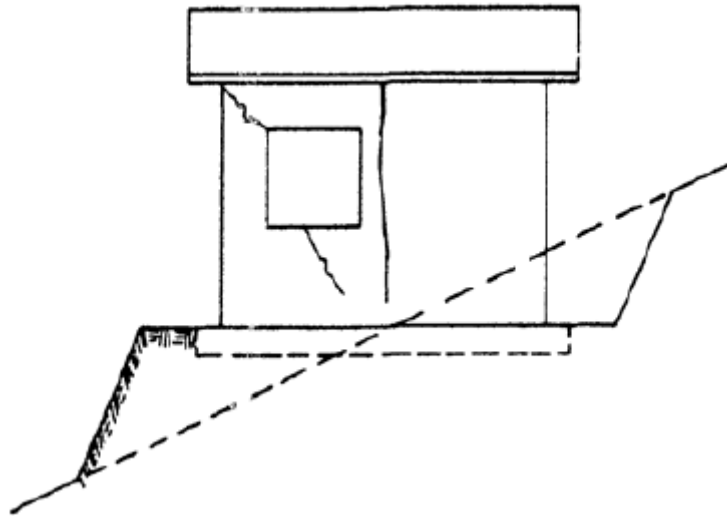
Fissuras originárias de escorregamento do solo
